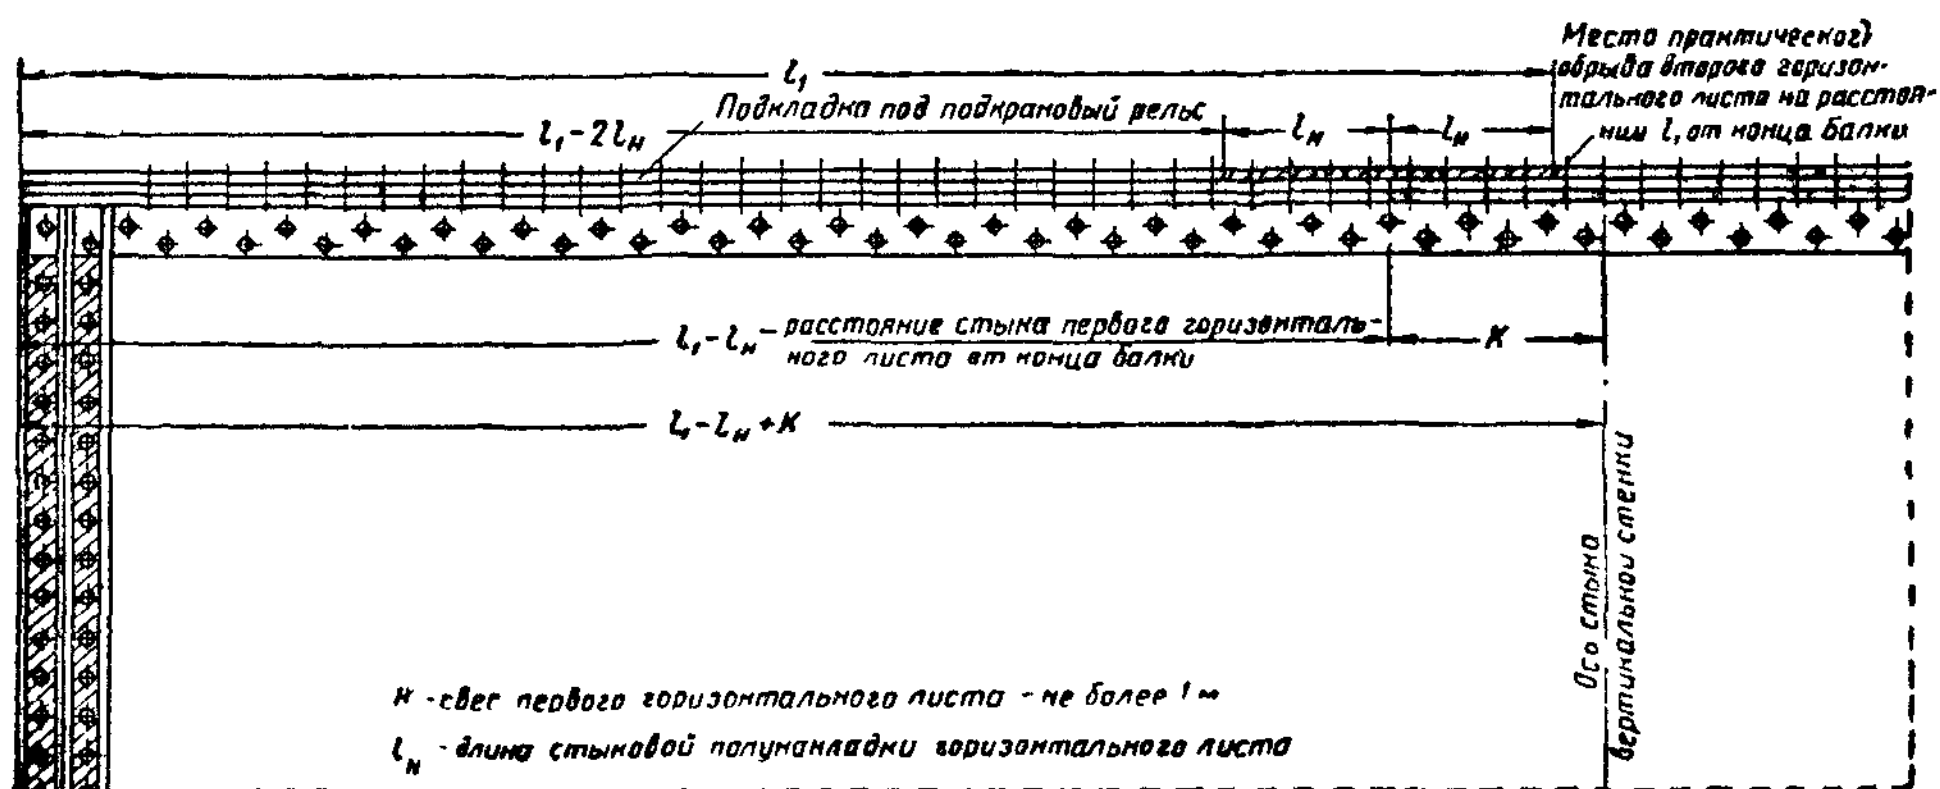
Вариант стыка горизонтального листа верхнего пояса подкрановой балки у места обрыва листа
